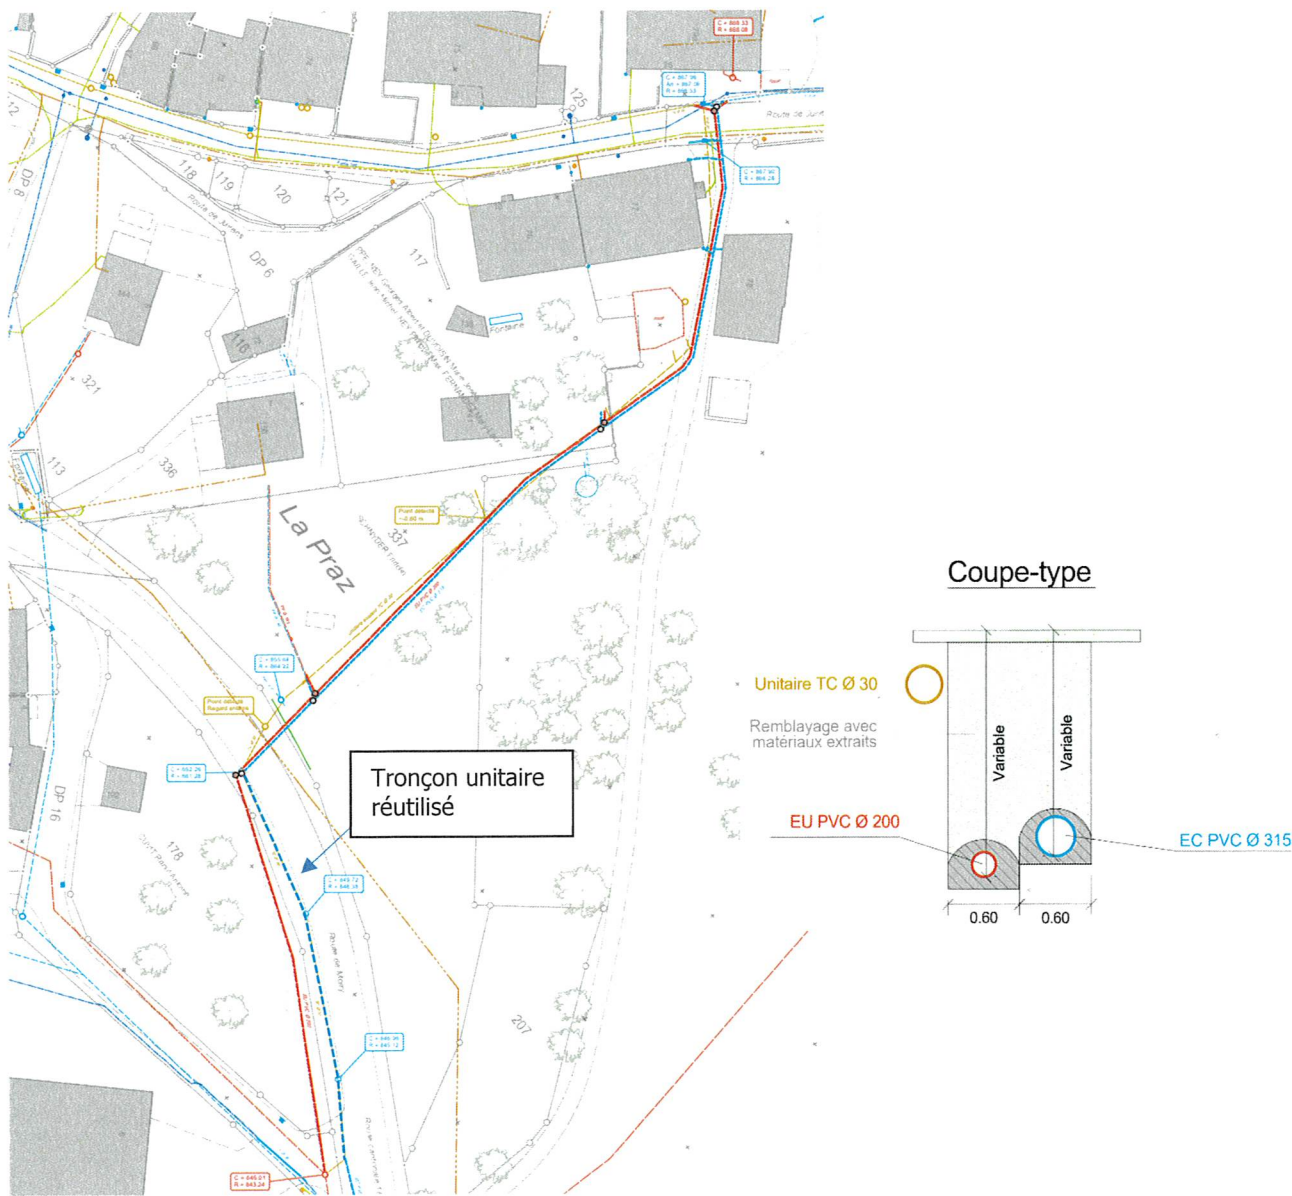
Plan des nouvelles canalisations EC et EU
